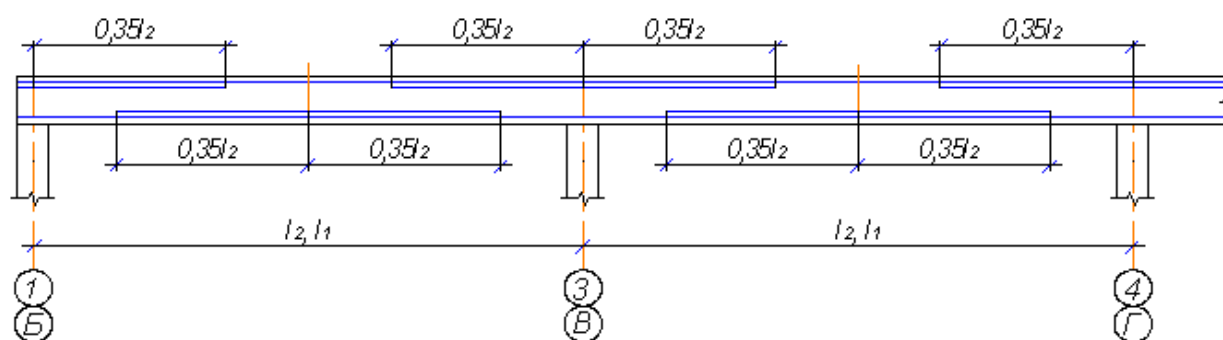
Схема дополнительного нижнего и верхнего армирования
